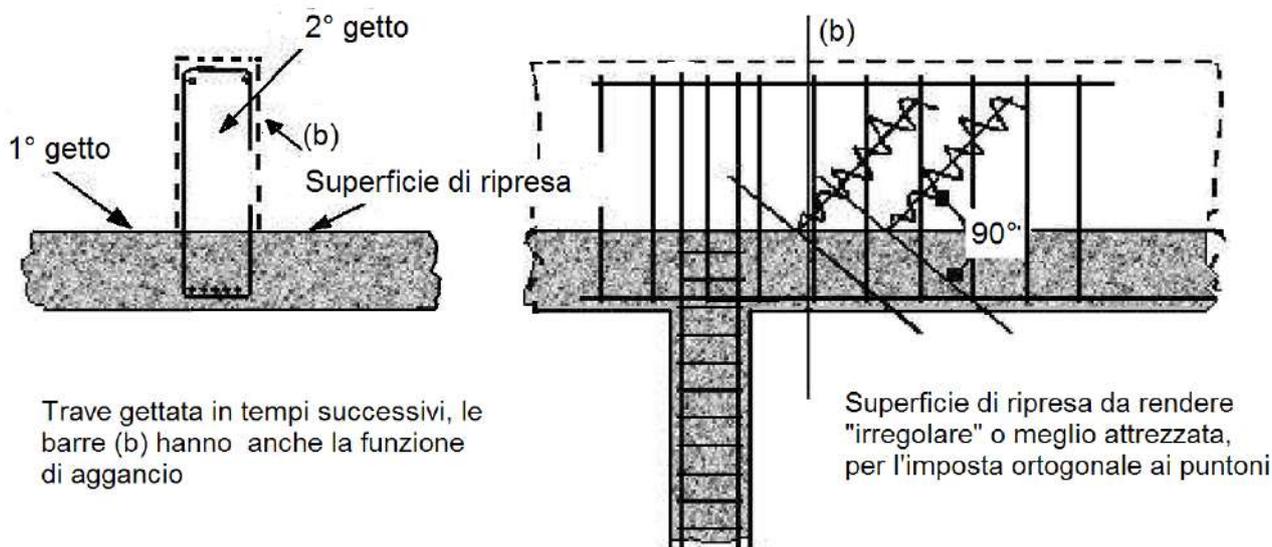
Modalità di ripresa del getto su travi di spessore elevato
